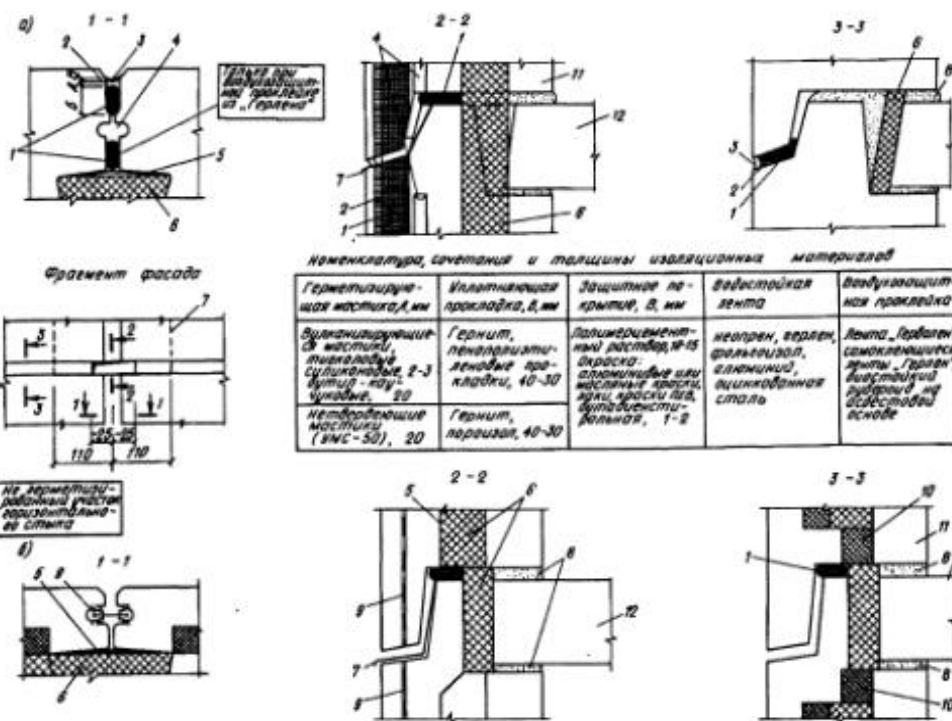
Изоляция стыков бетонных наружных стен: а - изоляция стыков легкобетонных панелей (по принципу дренажного стыка); б - изоляция стыков трехслойных панелей (по принципу открытого стыка); 1 - уплотняющая прокладка; 2 - герметизирующая мастика; 3- защитное покрытие; 4 - декомпрессионная полость; 5 - воздухозащитная прокладка; 6 - утепляющий вкладыш; 7 - водоотводящий фартук; 8 - цементный раствор; 9 - водоотбойная лента; 10 - негорючий утеплитель; 11 - панель наружной стены; 12- панель перекрытия
